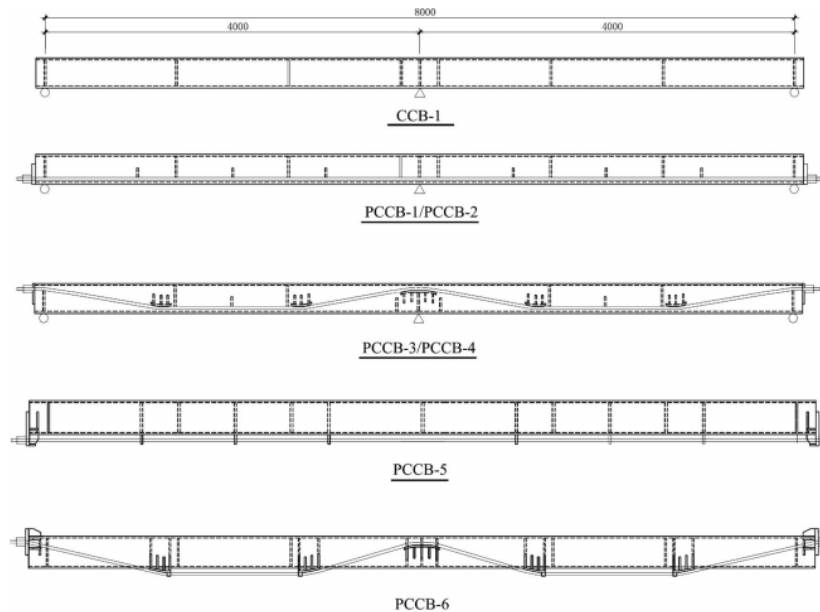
Vista longitudinal e da seção transversal das vigas mistas protendidas ensaiadas por Chen, Wang e Jia (2009)
